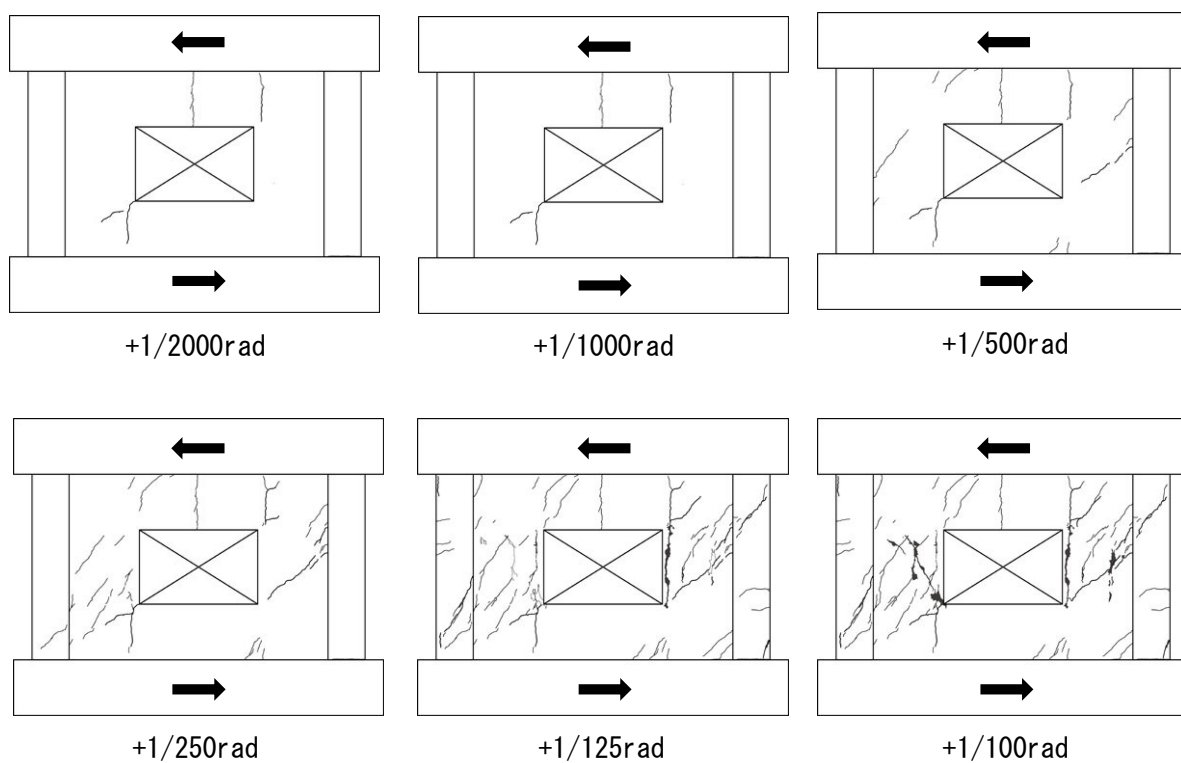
各層間変形角のひび割れ状況図 (F7-SWC-1.0)
